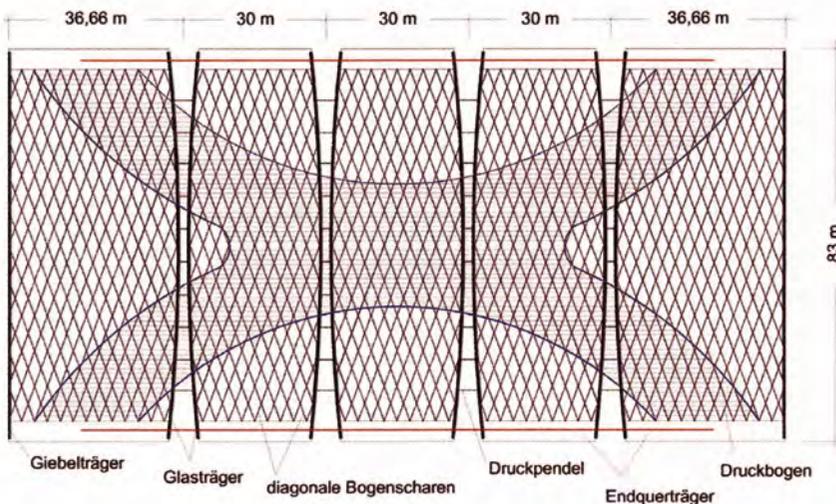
Messe Karlsruhe, Merzweckhalle, Dachtragwerk
